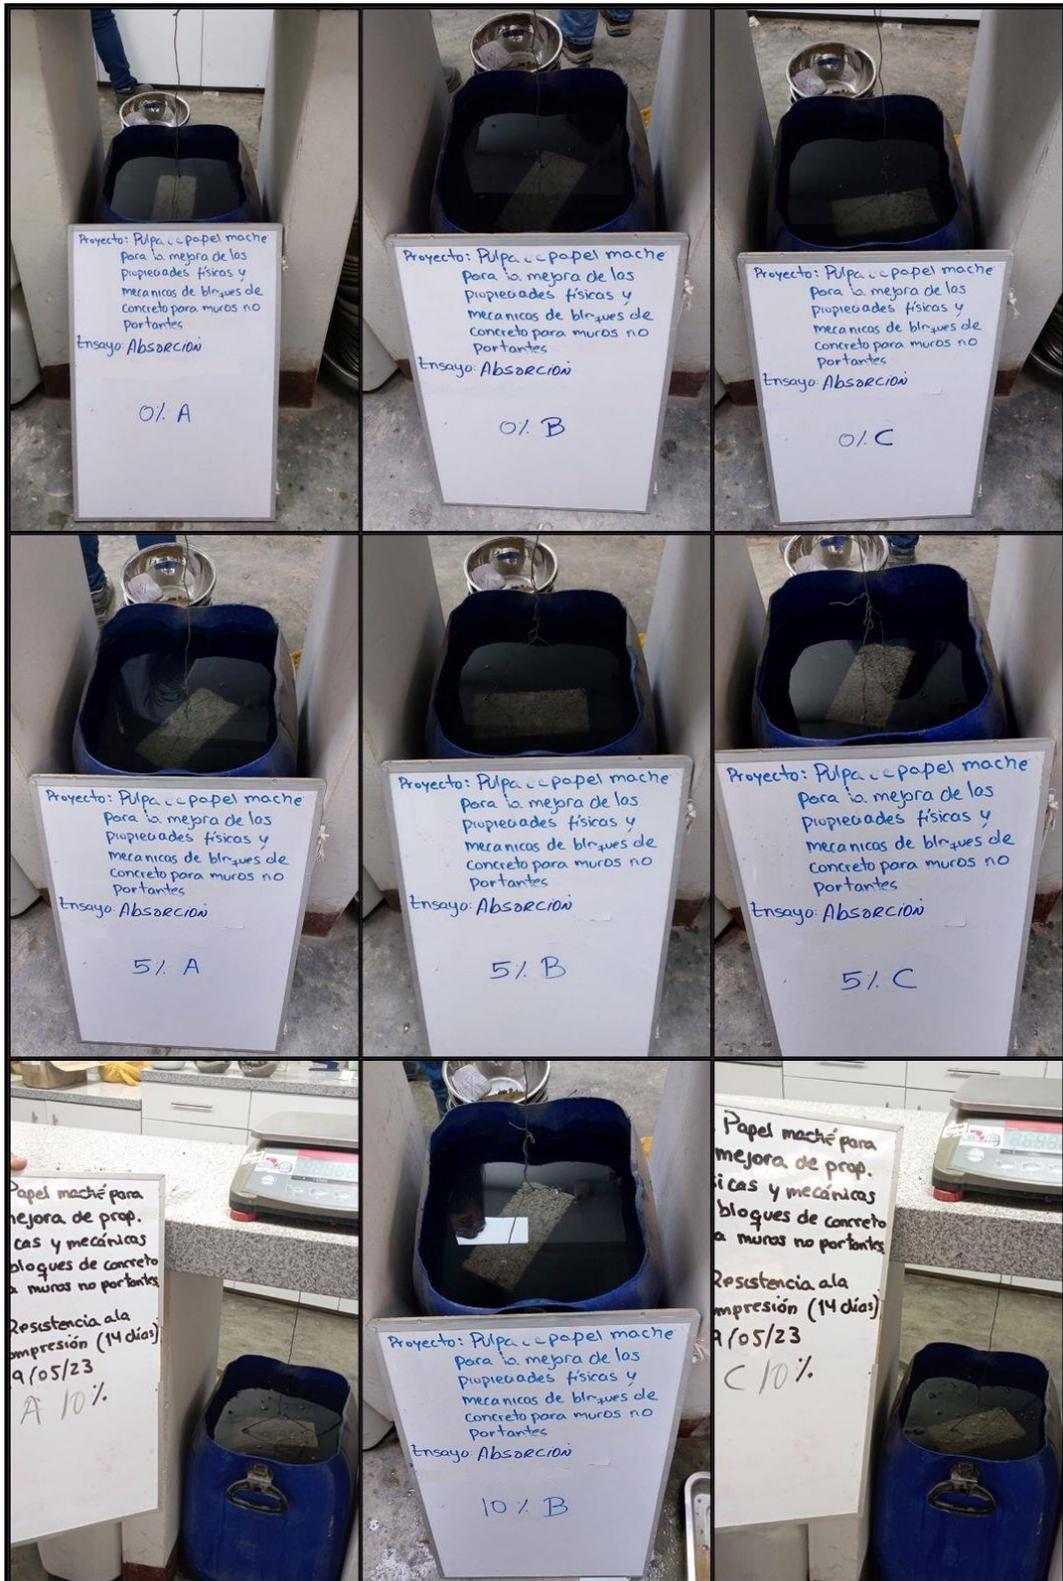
FOTOS DE ENSAYOS DE COMPRESIÓN DE BLOQUES DE CONCRETO
